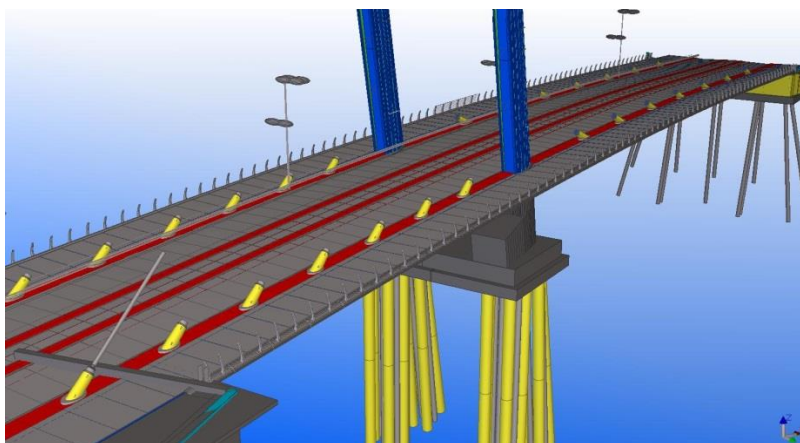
Modelo BIM Crusell Bridge (TEKLA, 2009)
